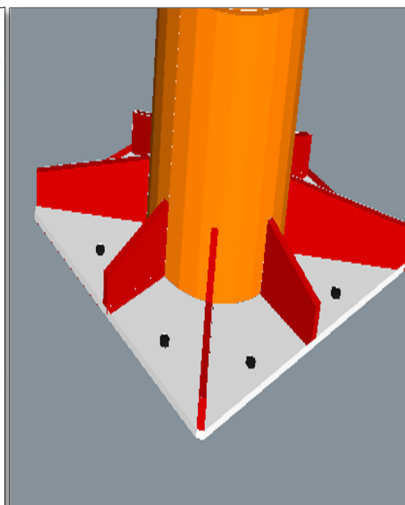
Fixation d'un poteau circulaire métallique sur une fondation
